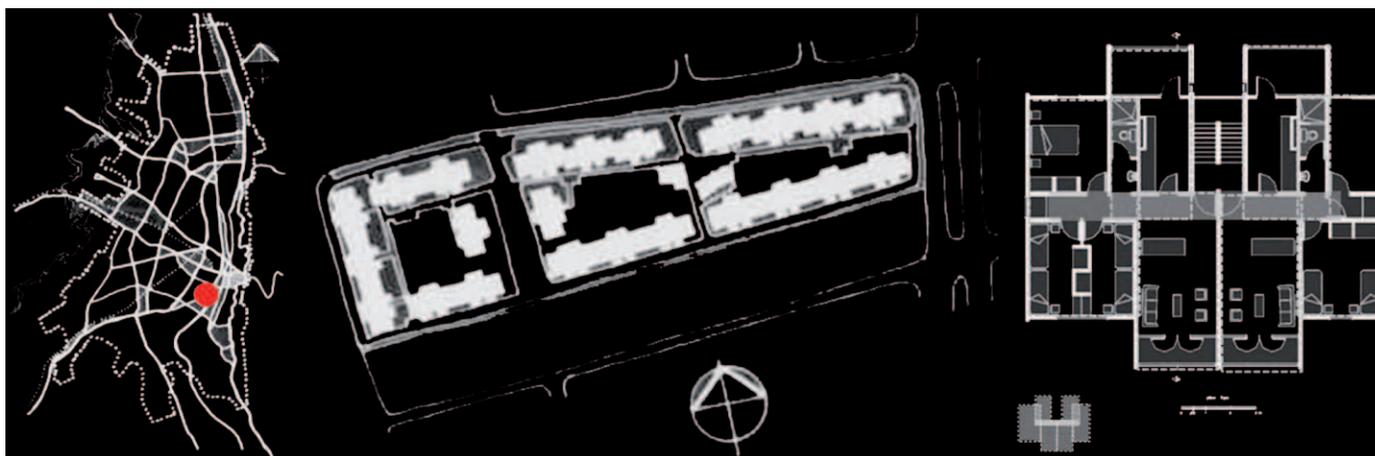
Ubicación del proyecto en la ciudad, desarrollo urbanístico y planta tipo del proyecto original Unidad Hans Drews Arango (1962)
